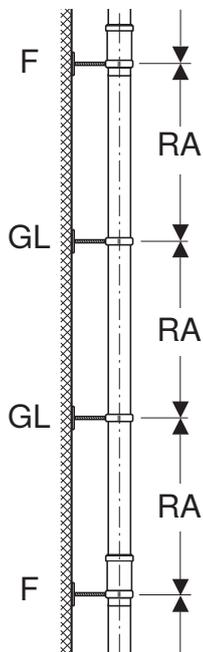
Расстояние между хомутами RA при вертикальном креплении к стенам
